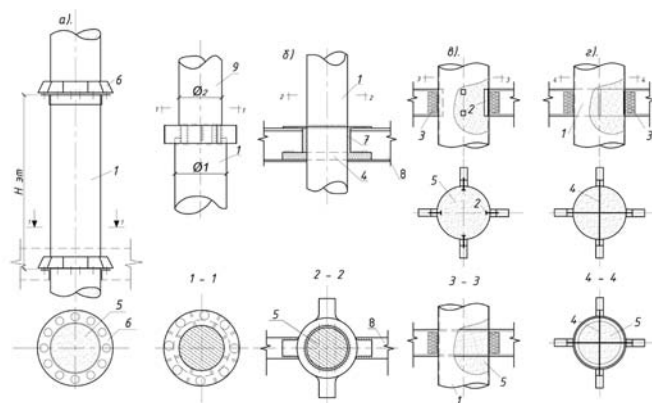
Конструктивные решения по сопряжению трубобетонных колонн с ригелями:
